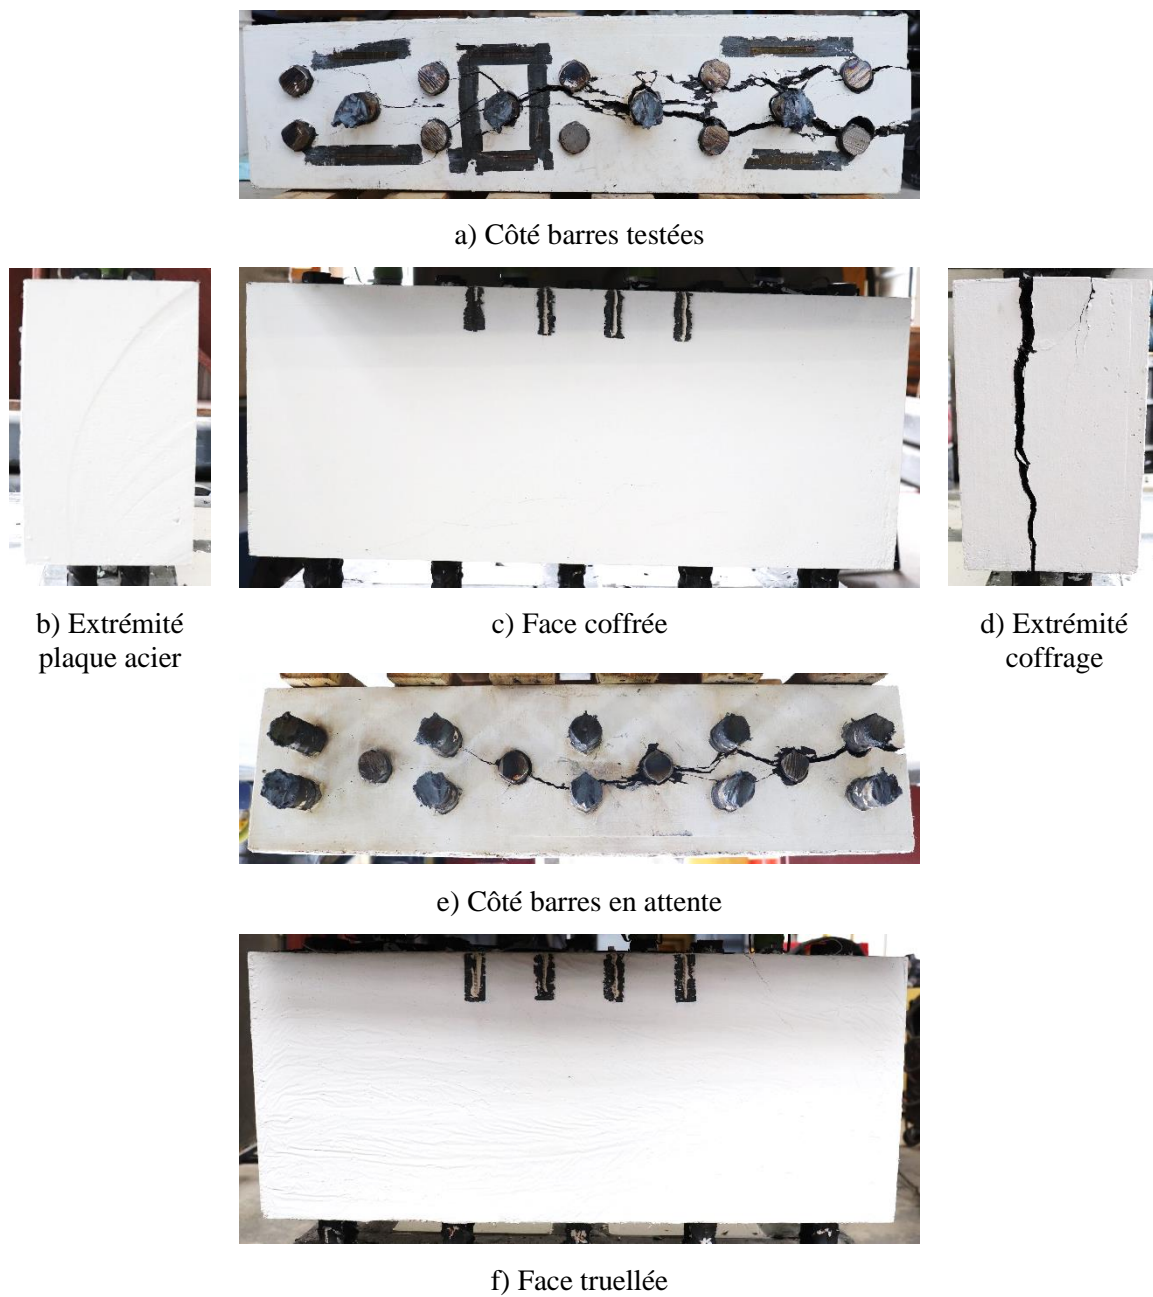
Fissuration observée en laboratoire - Spécimen DNCO
